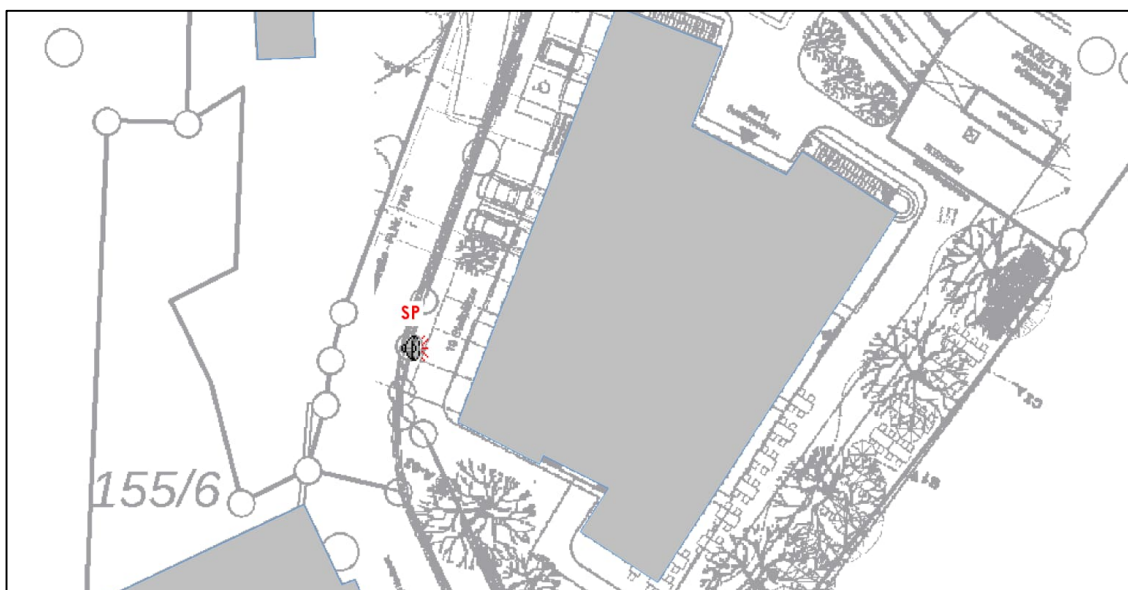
Lageplan /28, 40/ mit Eintragung der Punktschallquellen SP (Spitzenpegel)
